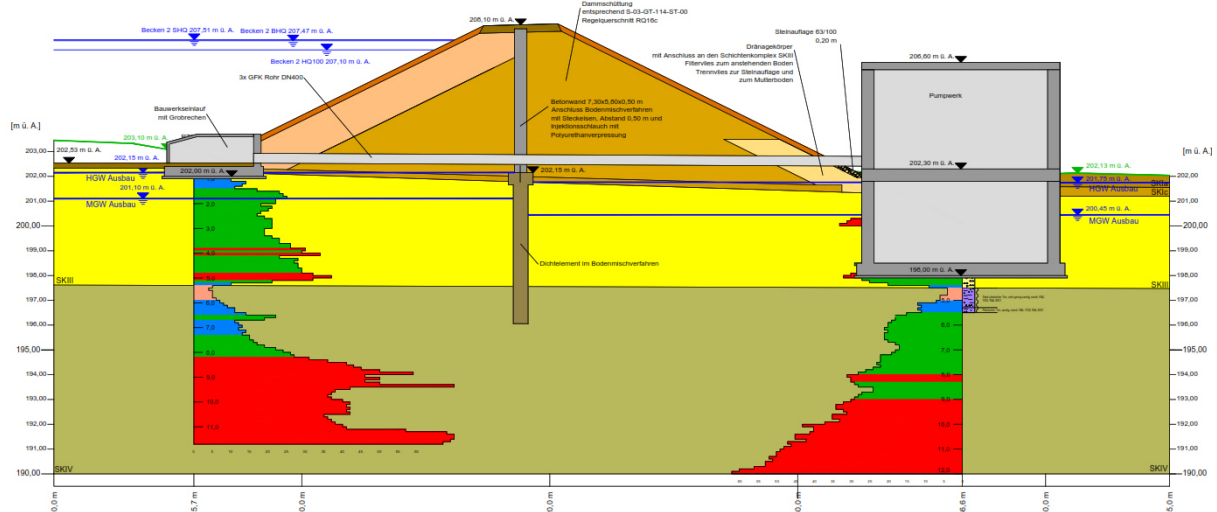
Regelquerschnitt 16c. Benetzung der gesamten Dammaufstandsfläche durch HGW-Niveau
